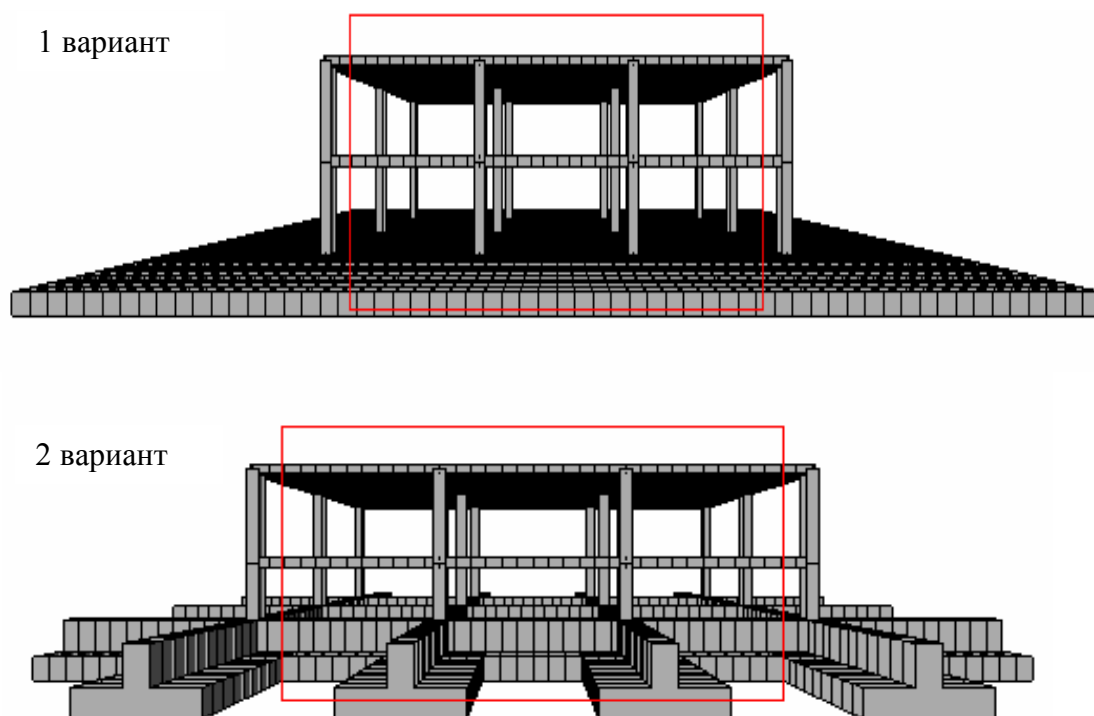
Расчетная схема исследуемого здания с традиционными мерами противокарстовой защиты: 1 вариант – фундамент в виде сплошной плиты; 2 вариант – фундамент в виде перекрестных балок.
